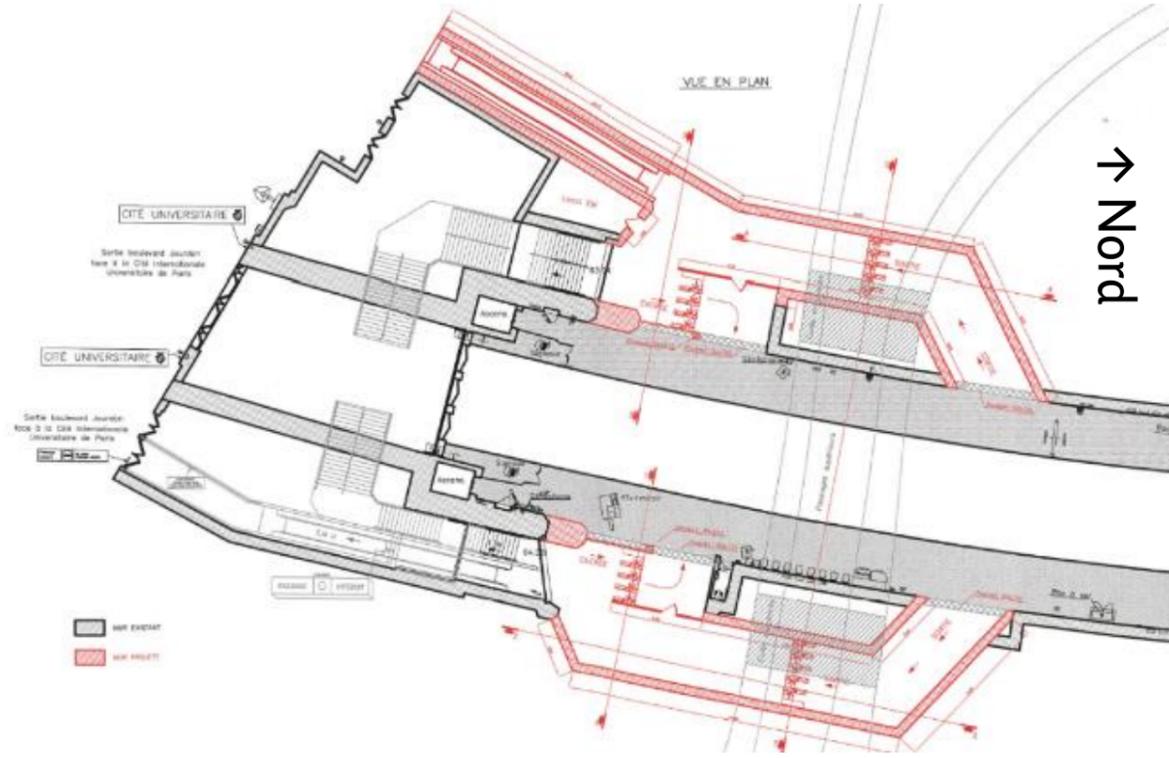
Plans du scénario faisabilité de 2015, source : RATP
